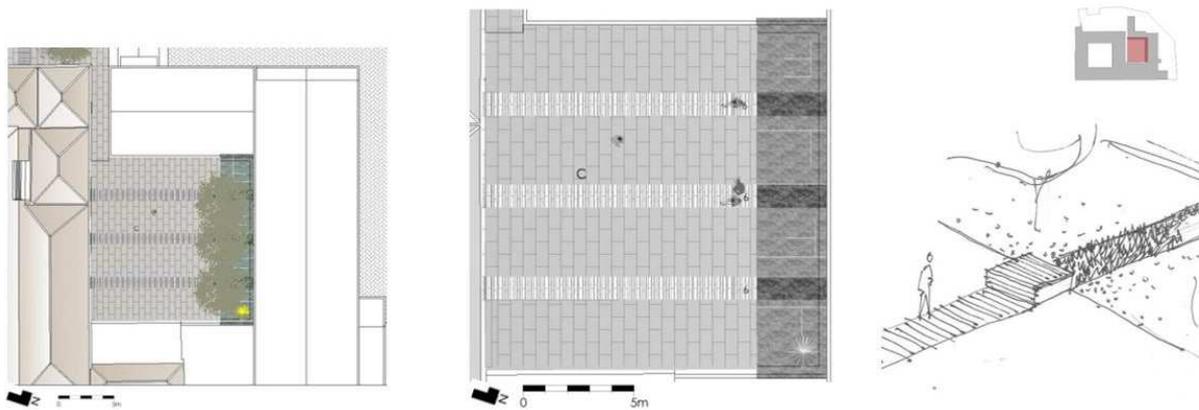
À esquerda, imagem da planta geral; ao centro, planta com esteotomia do pavimento e relação entre área pavimentada e plantada; esquiços das “caixas-de-sentar”, o material que define a faixa de pavimento prolonga-se pelo assento.
